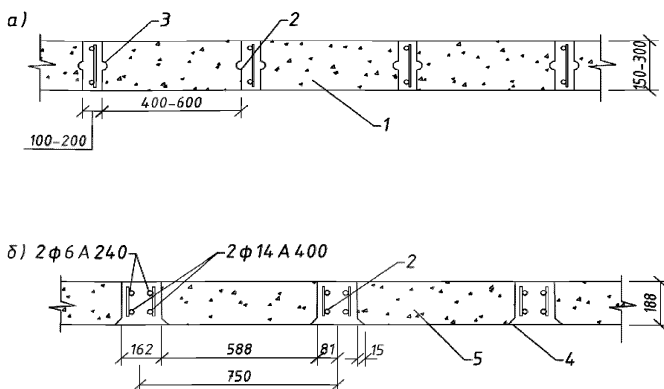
Сборно-монолитные перекрытия для зданий, возводимых при отсутствии монтажных кранов:
